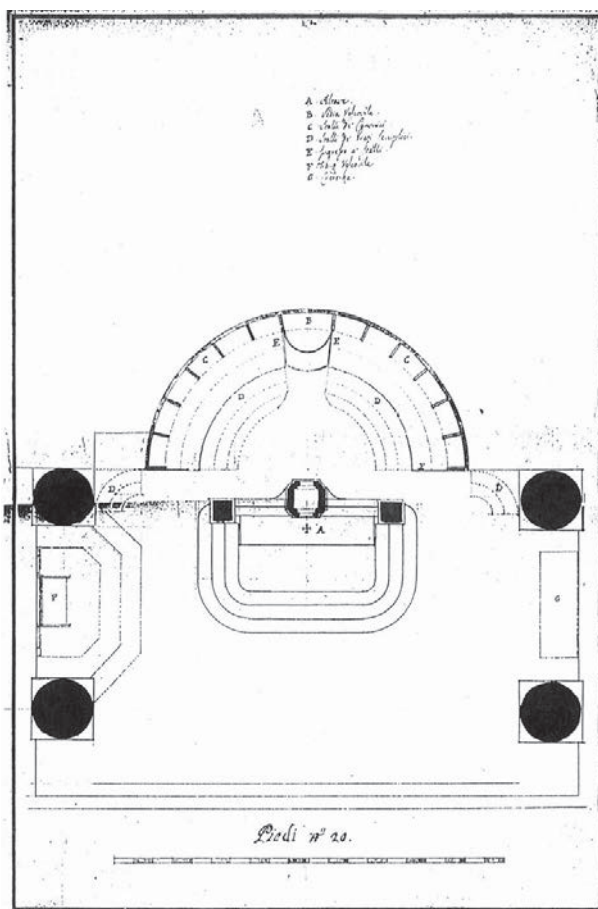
Planimetria del progetto, non realizzato, di rifacimento del presbiterio della Cattedrale di Curzola, ultimo quarto del XVIII secolo.
